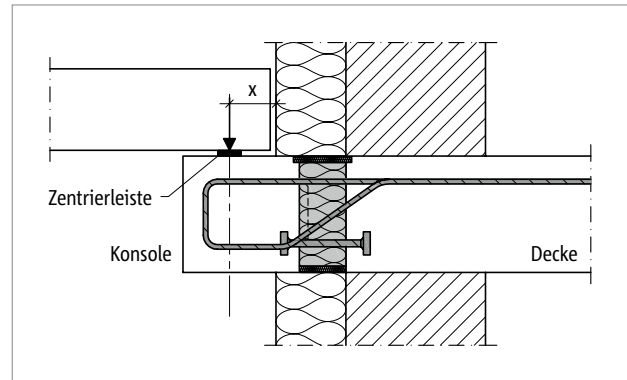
Schöck Isokorb® T Typ OP: Anschluss einer Konsole als Deckenauf- lager; Zentrierleisten verhindern eine Verschiebung des Lasteinleitungs- punktes
